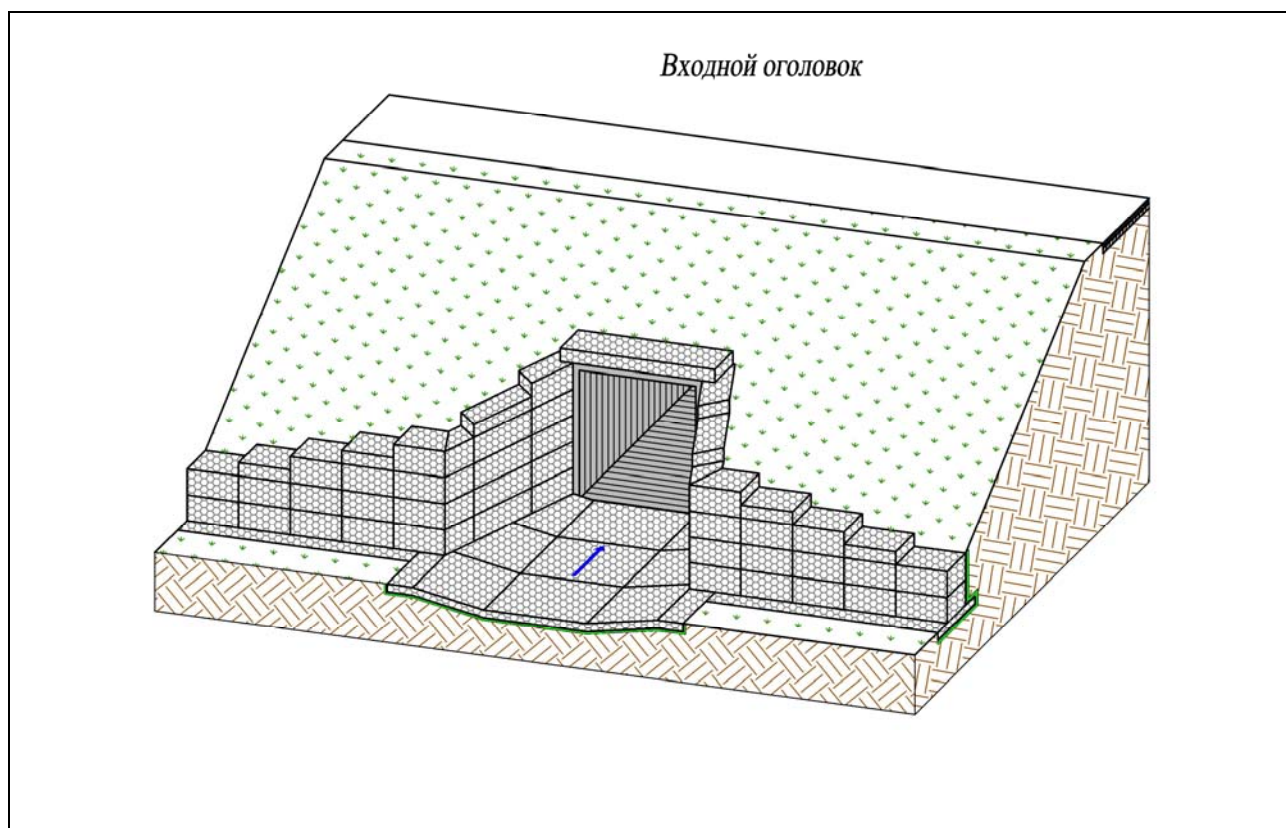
(продолжение) Укрепление оголовков водопропускной трубы открылками из габрионных конструкций
